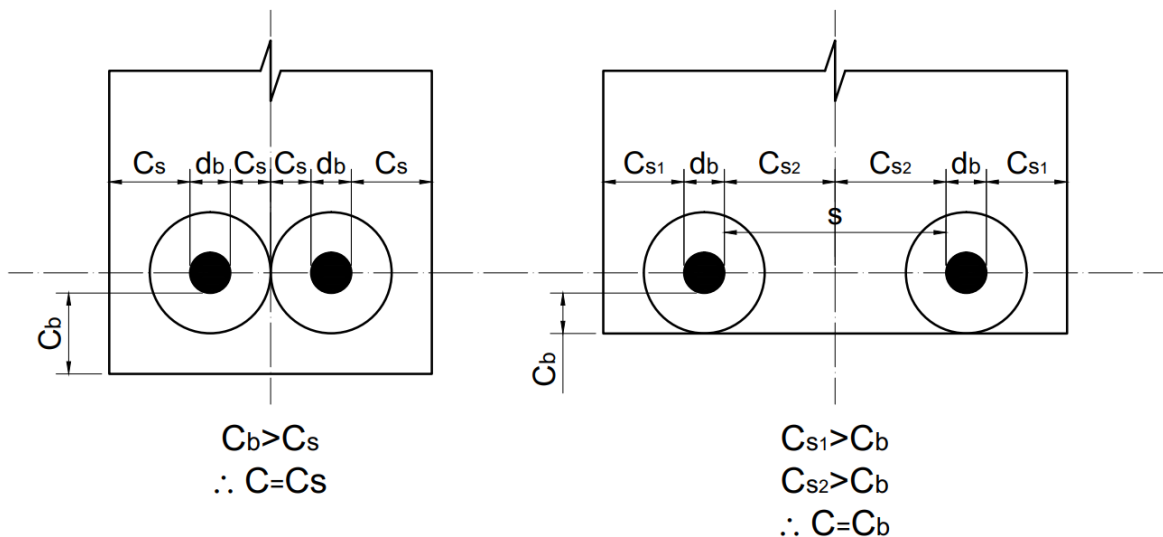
Hipótesis del cilindro de concreto para falla de agrietamiento longitudinal.
